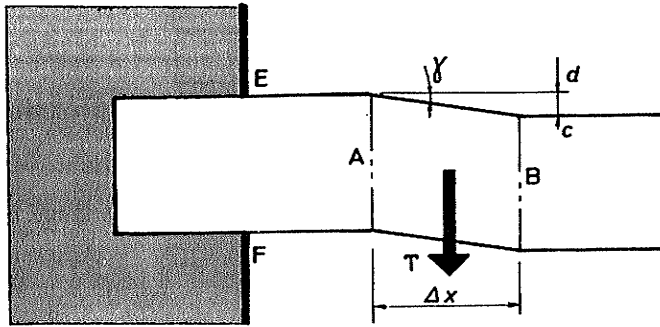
Poutre en béton, non armée, encastrée en EF. La section A et la section B, séparées par une distance très petite Δx , accusent, sous l'effet de l'effort tranchant T, une déviation $\gamma = \frac{dc}{\Delta x}$
